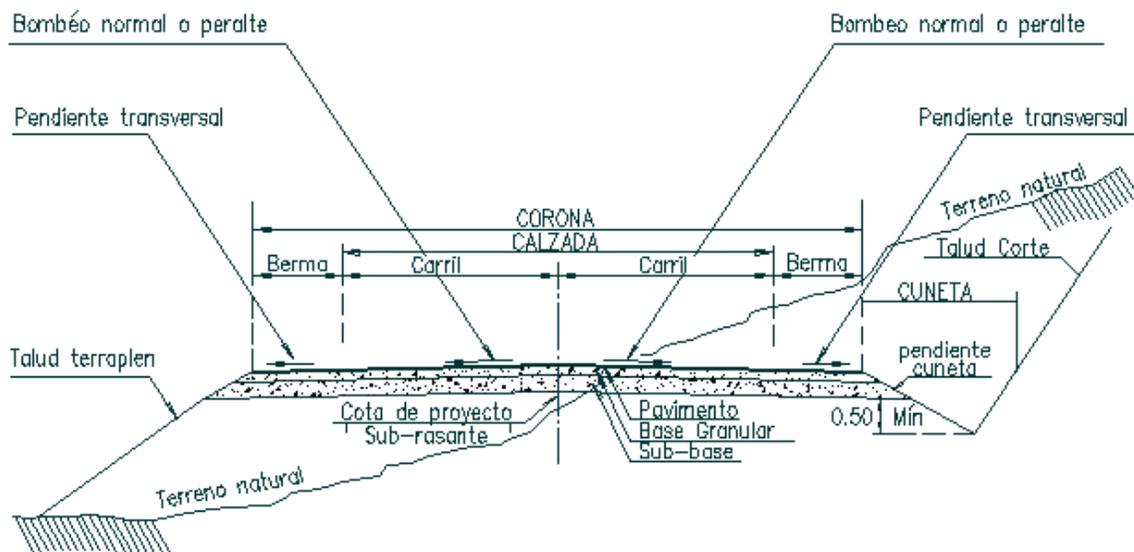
ELEMENTOS PRINCIPALES QUE FORMAN LAS SECCIONES DE CONSTRUCCION.
